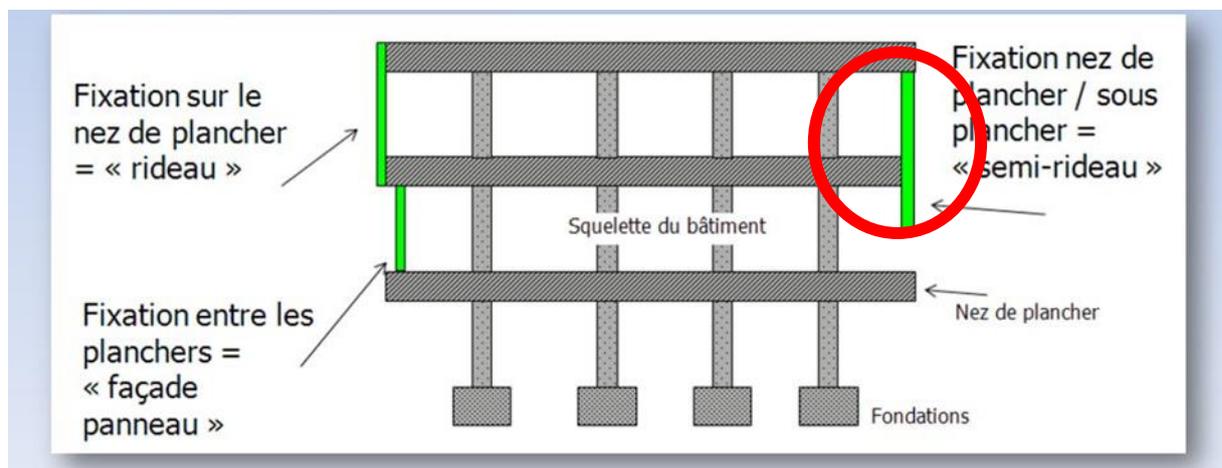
La façade semi rideau: nez de plancher/sous plancher
